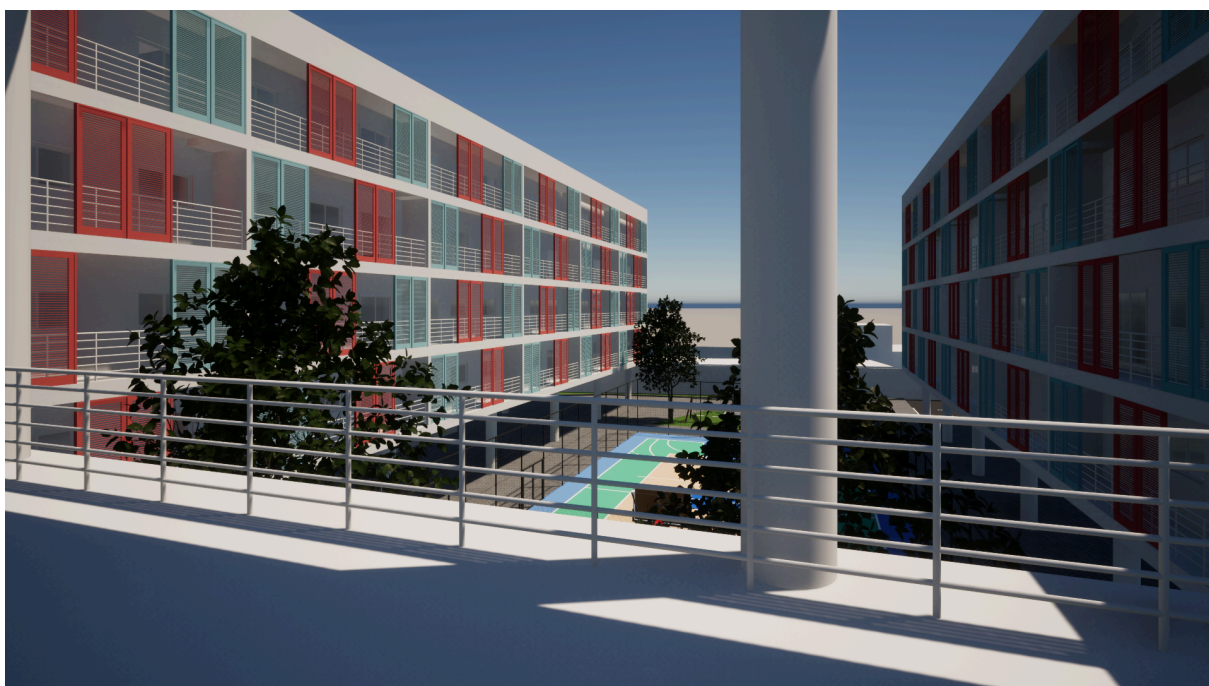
Perspectiva externa da edificação (vista passarela). Fonte: Produção do autor, 2024.
